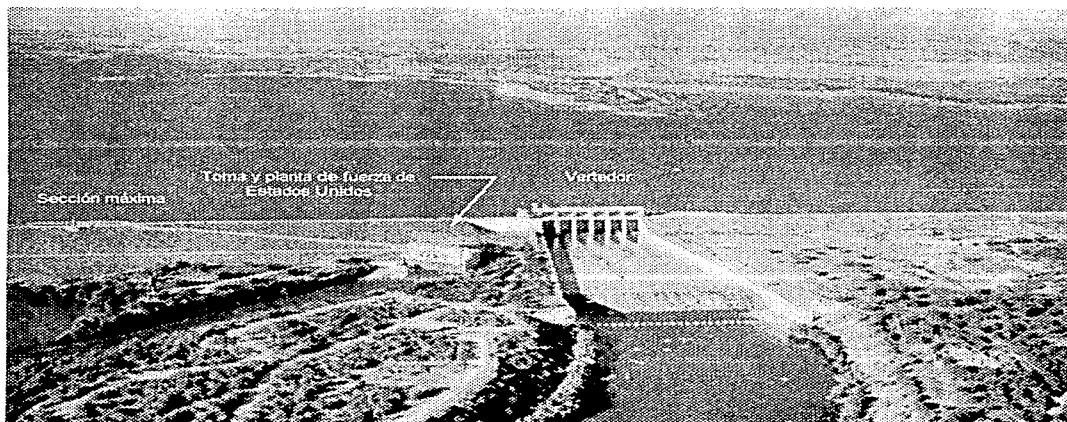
Vista aérea de la presa Falcón, se aprecia el vertedor y la planta de fuerza de Estados Unidos.
